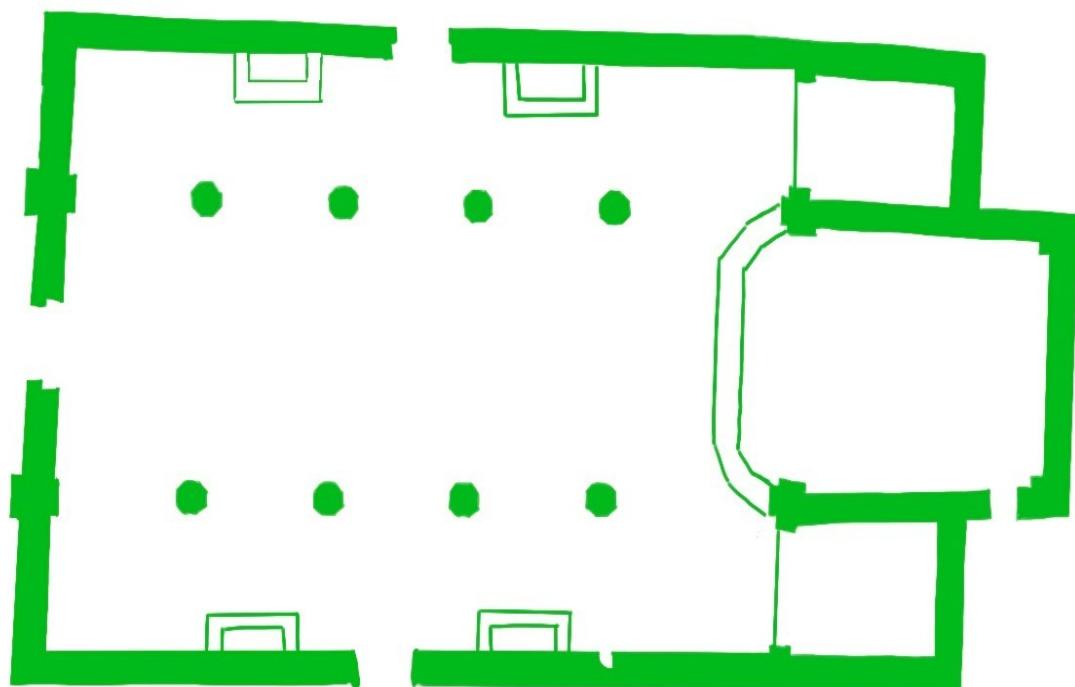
San Giovanni Decollato, Grundriss des heutigen Kirchenbaus
